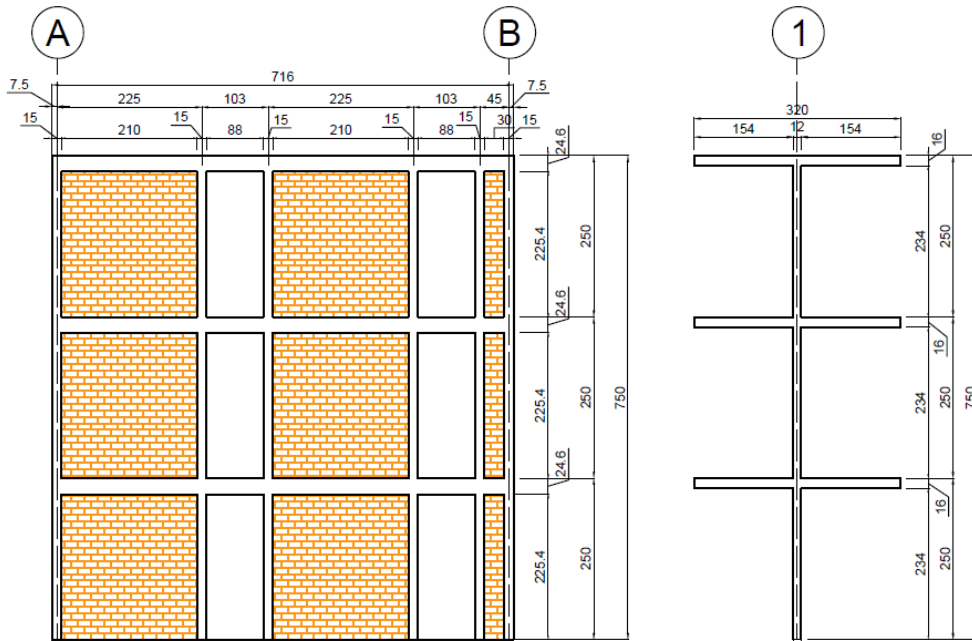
Configuración de estructura, vista lateral y corte transversal (dimensiones en cm).
